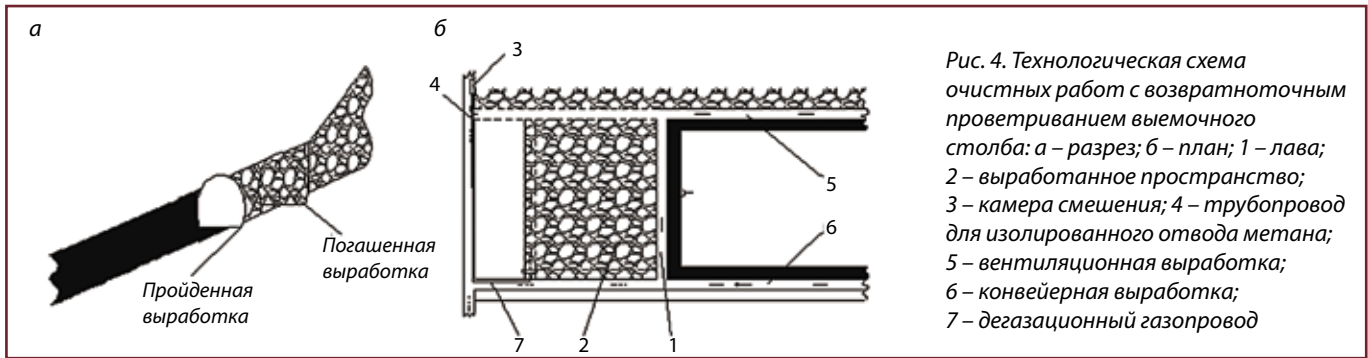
Технологическая схема очистных работ с возвратным проветриванием выемочного столба: а – разрез; б – план; 1 – лава; 2 – выработанное пространство; 3 – камера смешения; 4 – трубопровод для изолированного отвода метана; 5 – вентиляционная выработка; 6 – конвейерная выработка; 7 – дегазационный газопровод
